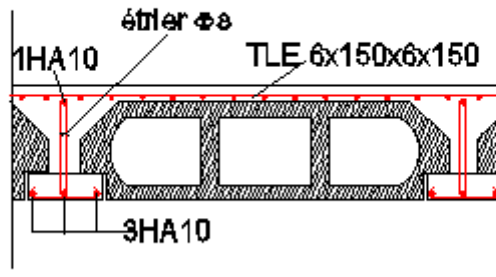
Schéma de ferraillage du plancher en corps creux.
